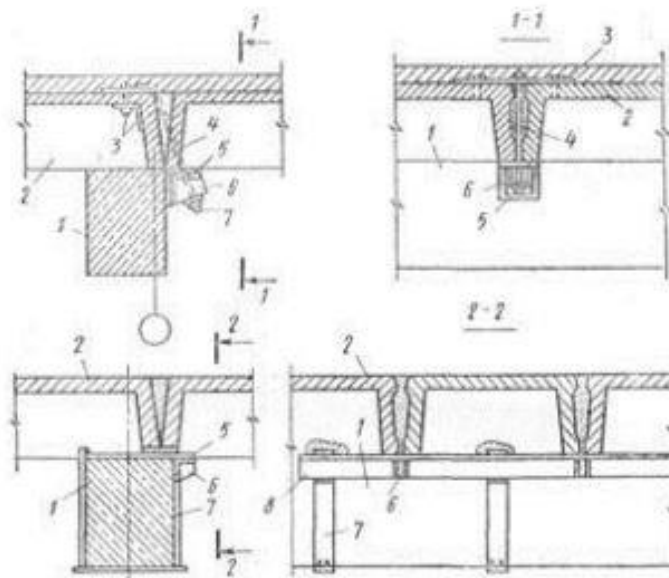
Усиление опирания плит: 1 — ригель; 2 — плита; 3 — крепление тяжа к плите; 4 — наклонный тяж; 5 — упорный столик; 6 — ребра жесткости; 7 — хомуты; 8 — уголок опорного столика
